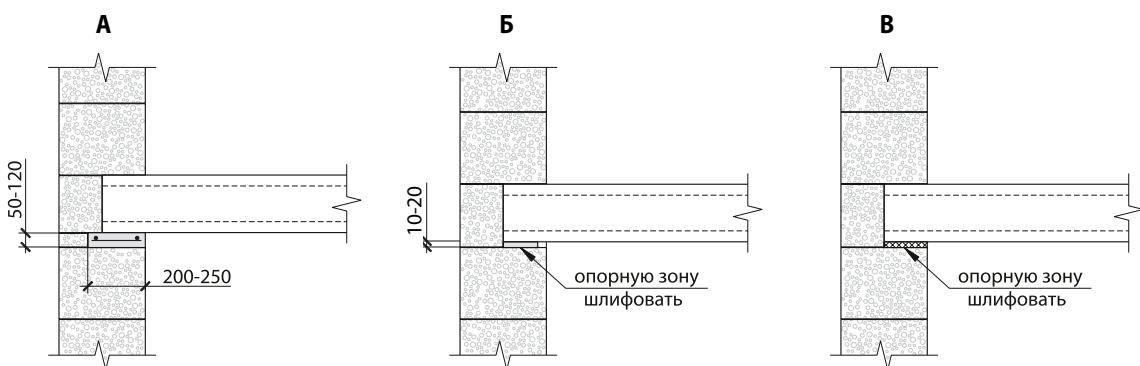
Варианты монтажа железобетонных перекрытий по стенам из блоков AEROC
